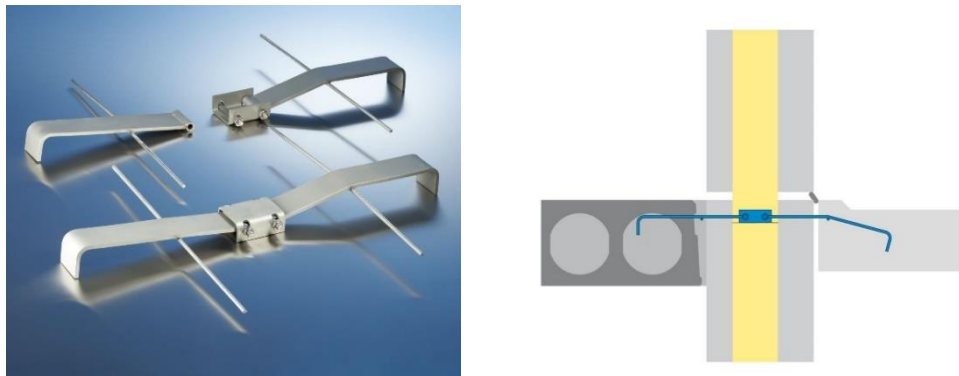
Schöck Isokorb ulokeparveketuenta (Schöck 2021)
